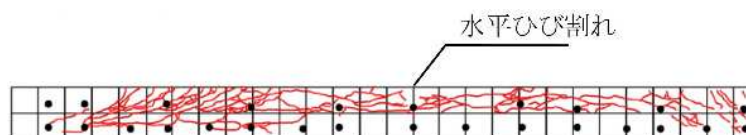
膨張材併用軽量 RC 床版のひび割れ図 (主鉄筋切断面)
